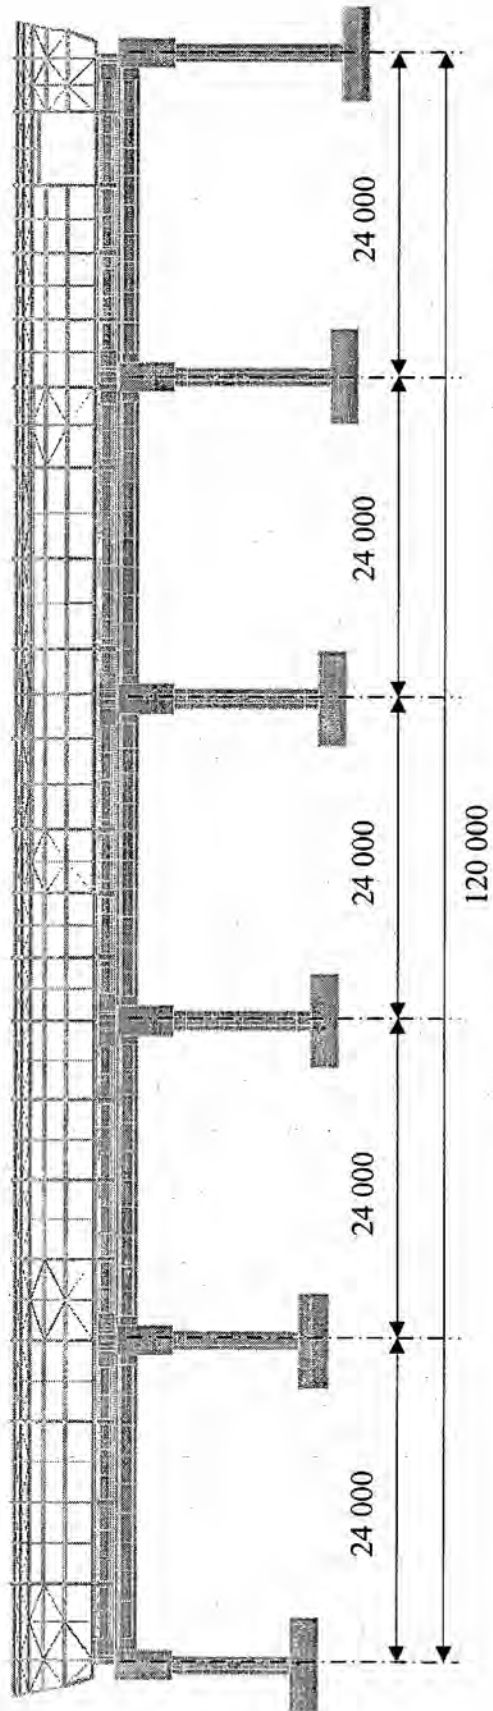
Vista Longitudinal de la Superestructura (Fuente: SAP 2000)
